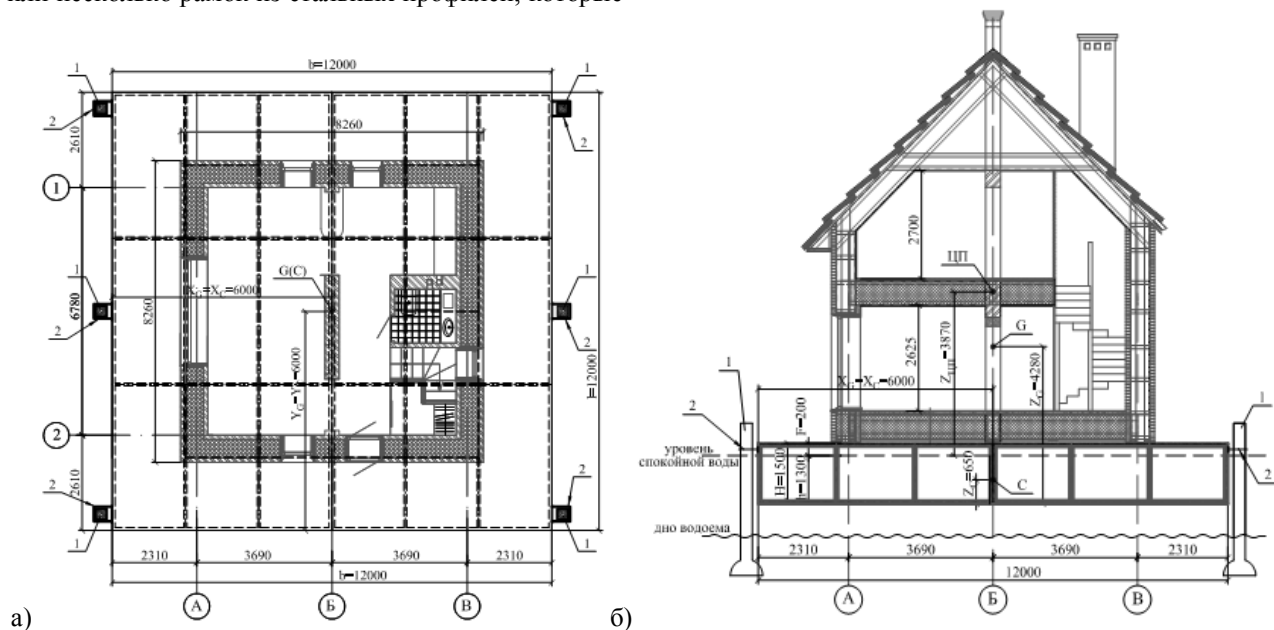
Проект-представитель двухэтажного здания на воде / Representative project of two-storey floating house: а) план 1-го этажа; б) разрез; 1 – направляющая стойка; 2 – закладная деталь для ограничения горизонтальных перемещений; h – осадка; F – высота надводного борта; C , G – центры тяжести подводной части и всего здания; $Z_{ЦП}$ – превышение центра парусности над плоскостью ватерлинии; Z_G , Z_C – превышение центра тяжести здания и его подводной части, соответственно, над плоскостью днища плавучей платформы / а) first floor layout; б) sectional view; 1 – guide column; 2 – embedded item for horizontal moving limitation; h – draught; F – free-board height; C , G – center of buoyancy and gravity center of building; $Z_{ЦП}$ – distance between a windage area and waterline surface; Z_G , Z_C – distances between gravity center of building and center of buoyancy and bottom surface of floating platform
